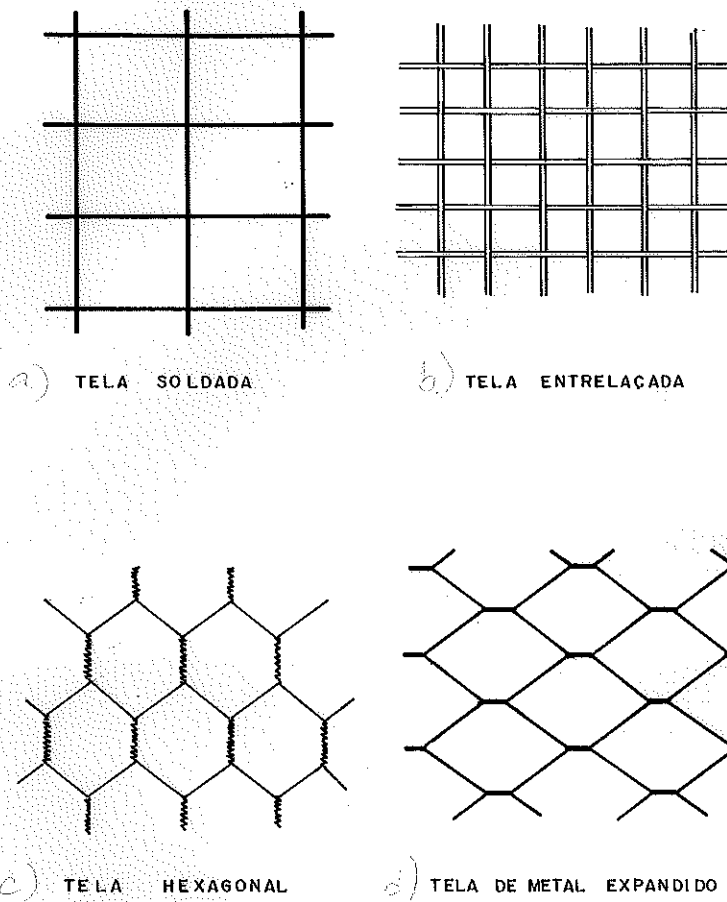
Tipos de telas utilizadas na argamassa armada.
